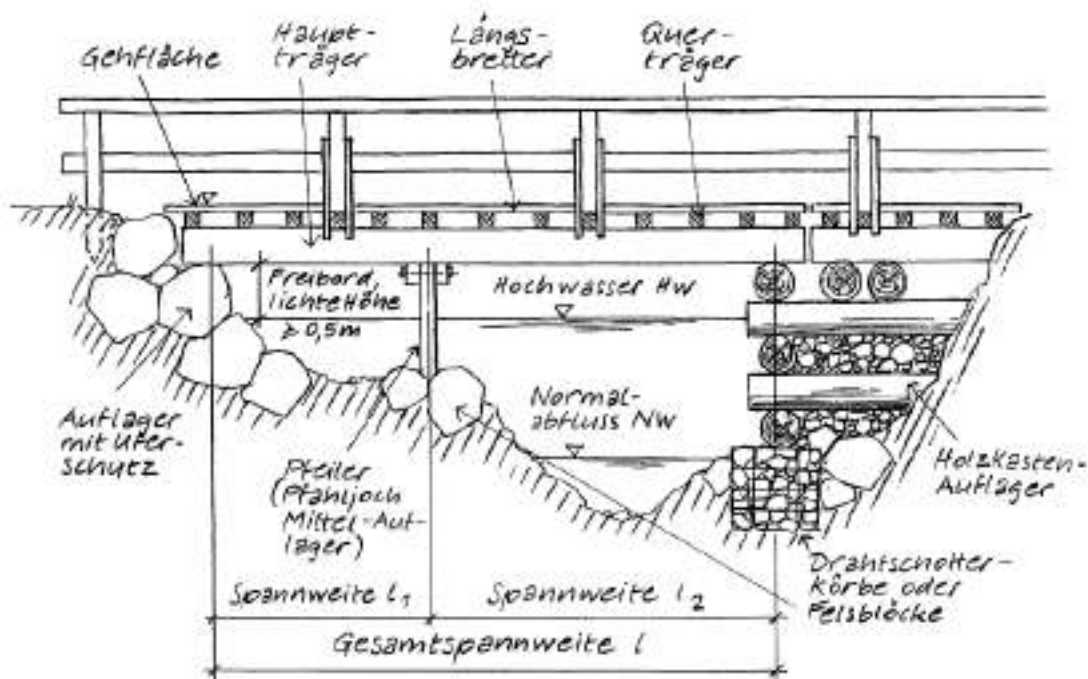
Grundkonstruktion einer Holzbrücke (ASTRA)
